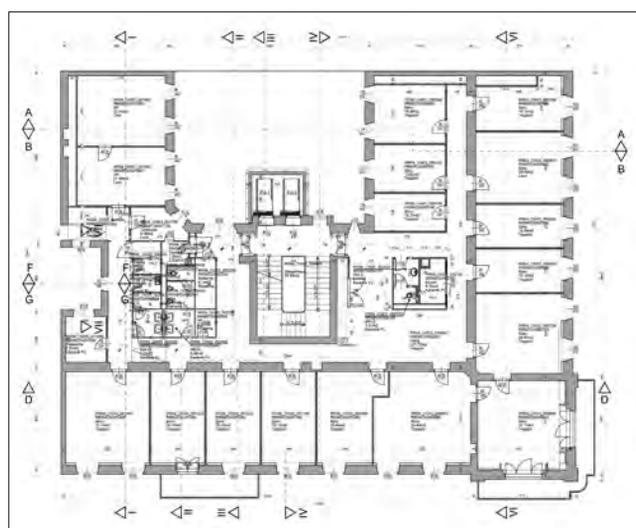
Reichsratsstraße 9, Regelgeschoß, Plandarstellung Palme Atelier.Architekt
